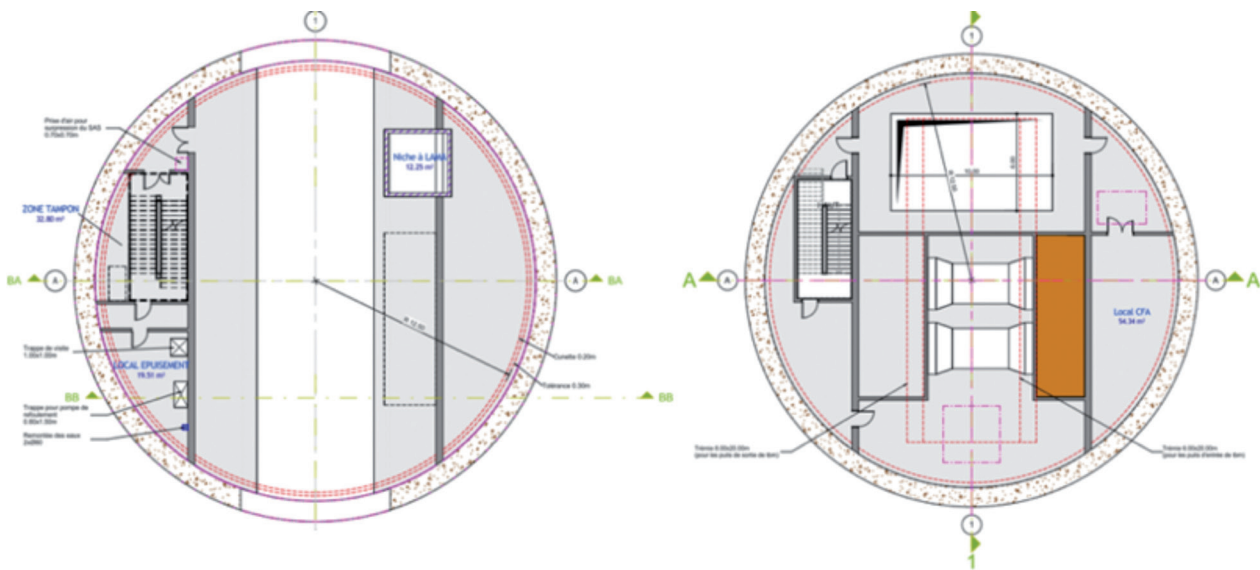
Vues en plan de plusieurs niveaux d'un puits type 6
